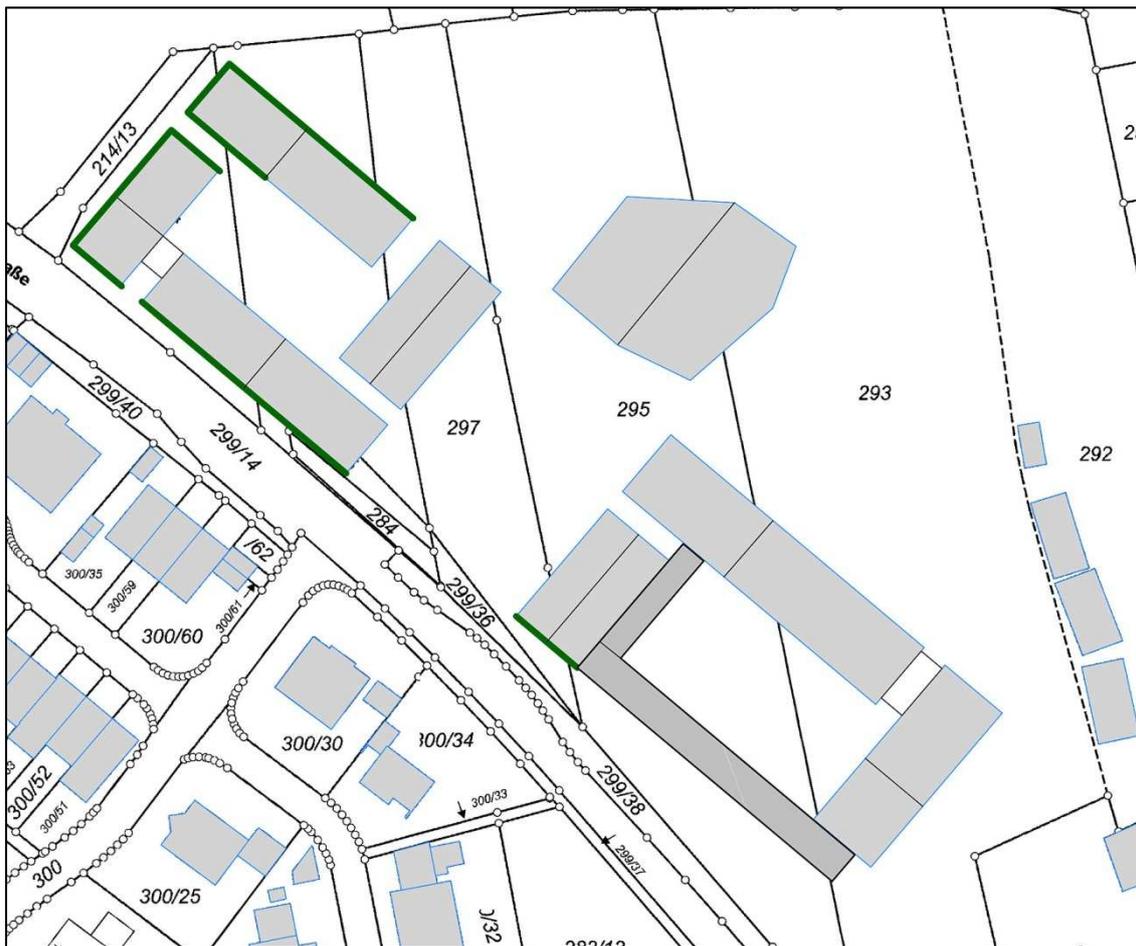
Lageplan mit Darstellung der Fassaden, an denen Schallschutzmaßnahmen empfohlen werden
